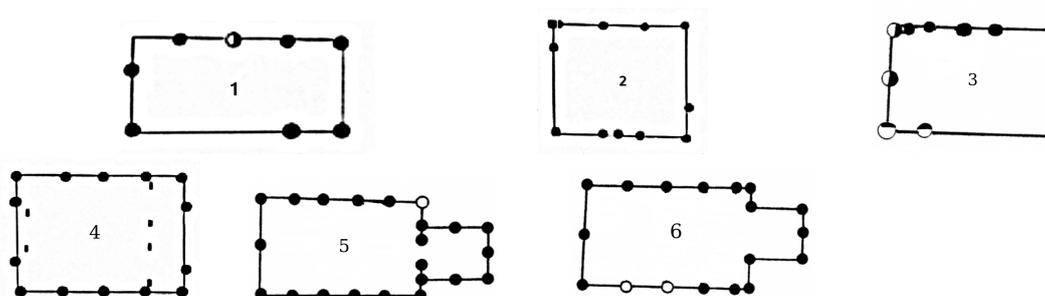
Grundrisse ergrabener Holzpfostenkirchen (nicht maßstabsgerecht).
